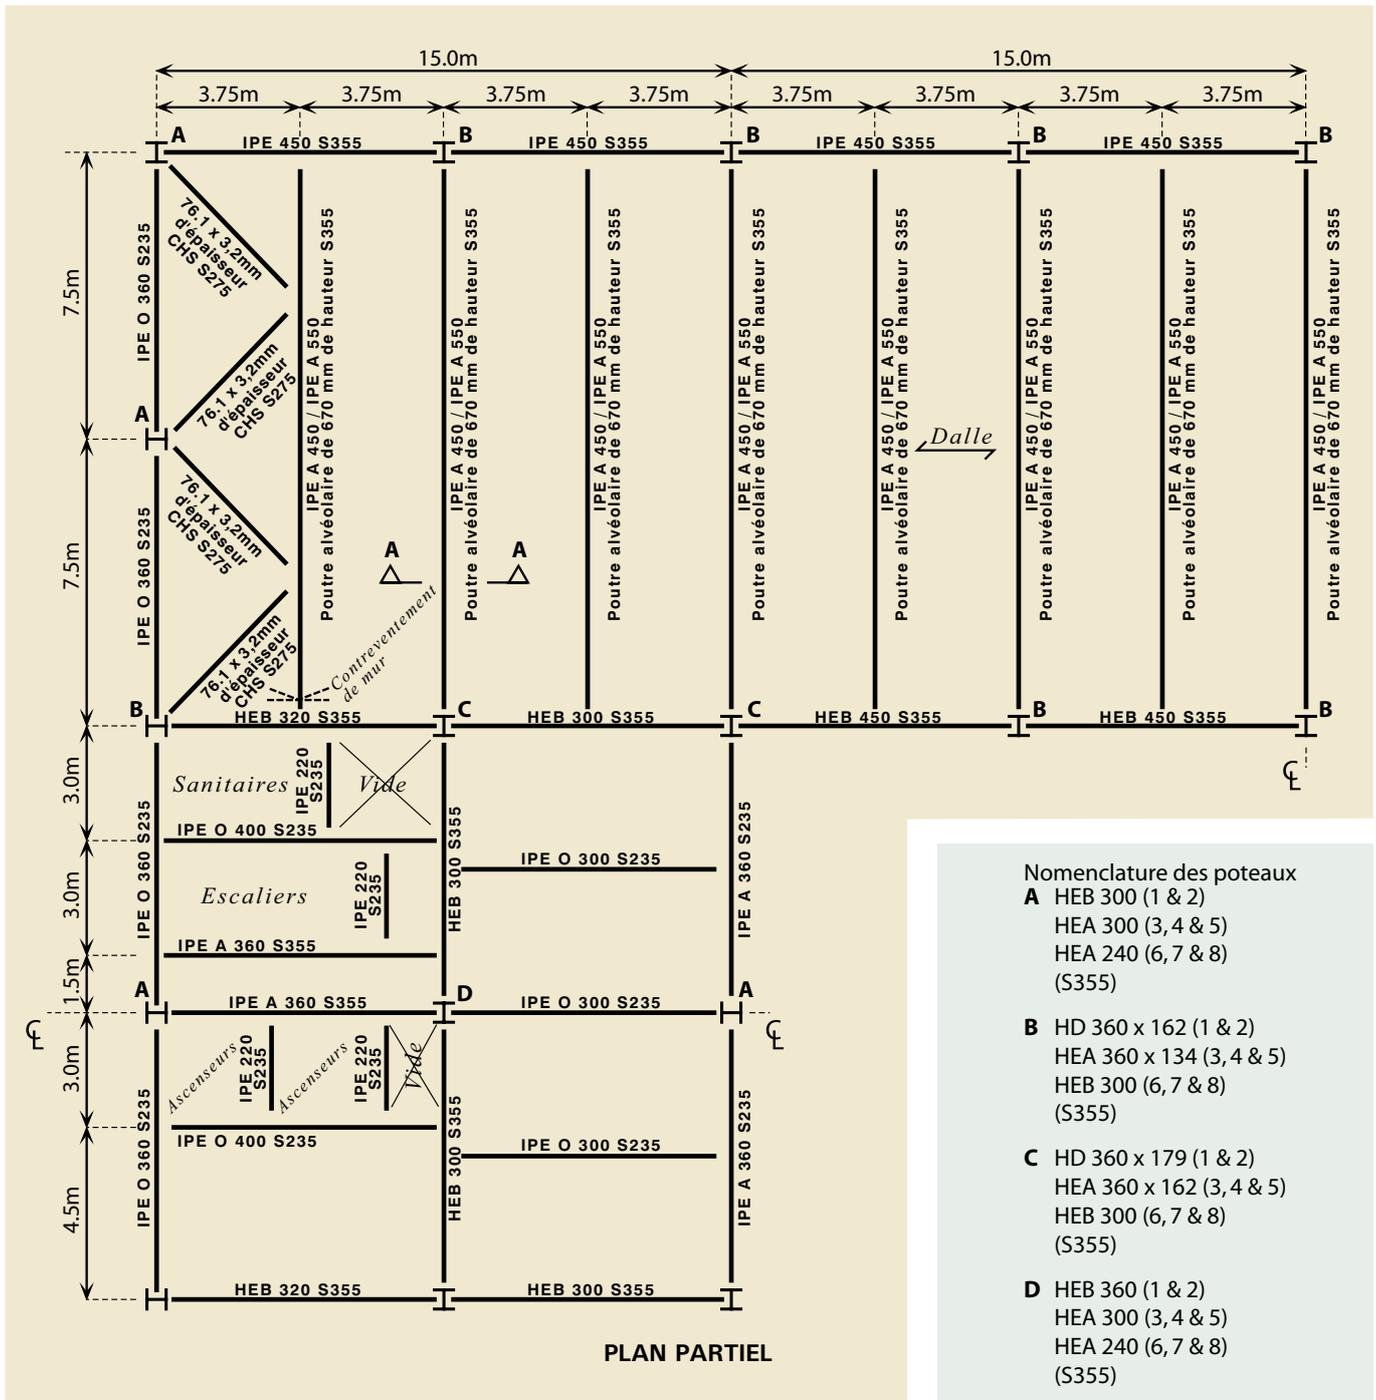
Poutres alvéolaires (poutres secondaires de grande portée) et dalles mixtes - exemple de disposition de structure de plancher en acier pour un bâtiment à trame rectangulaire de 8 étages
